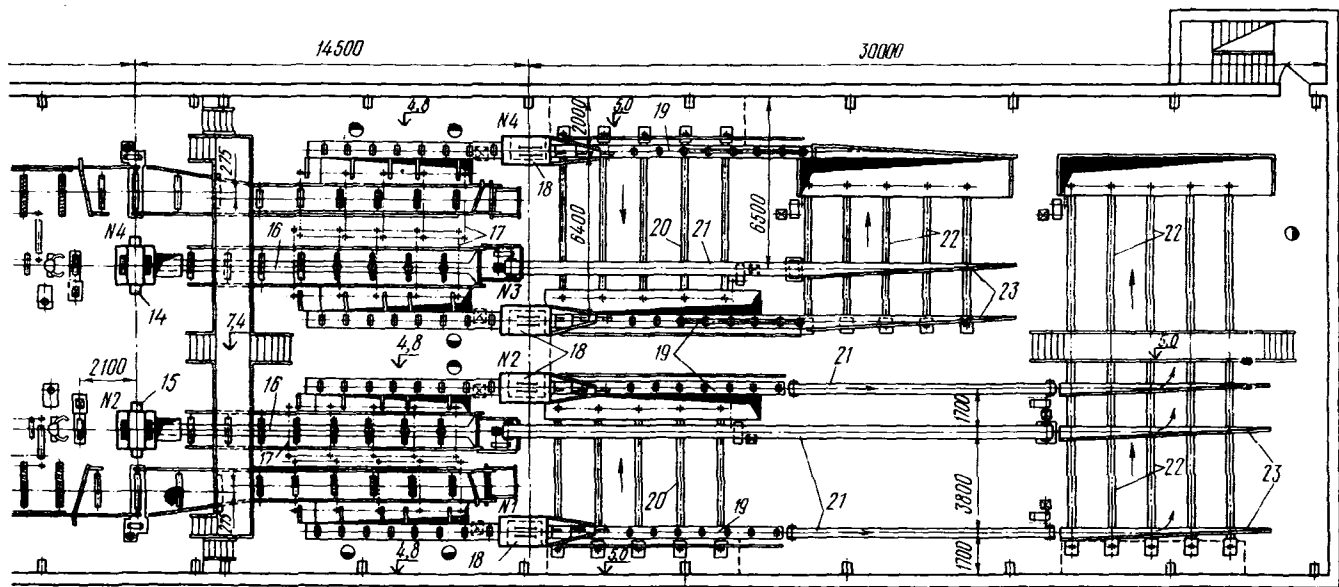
План второго этажа четырехрамного лесопильного цеха:
